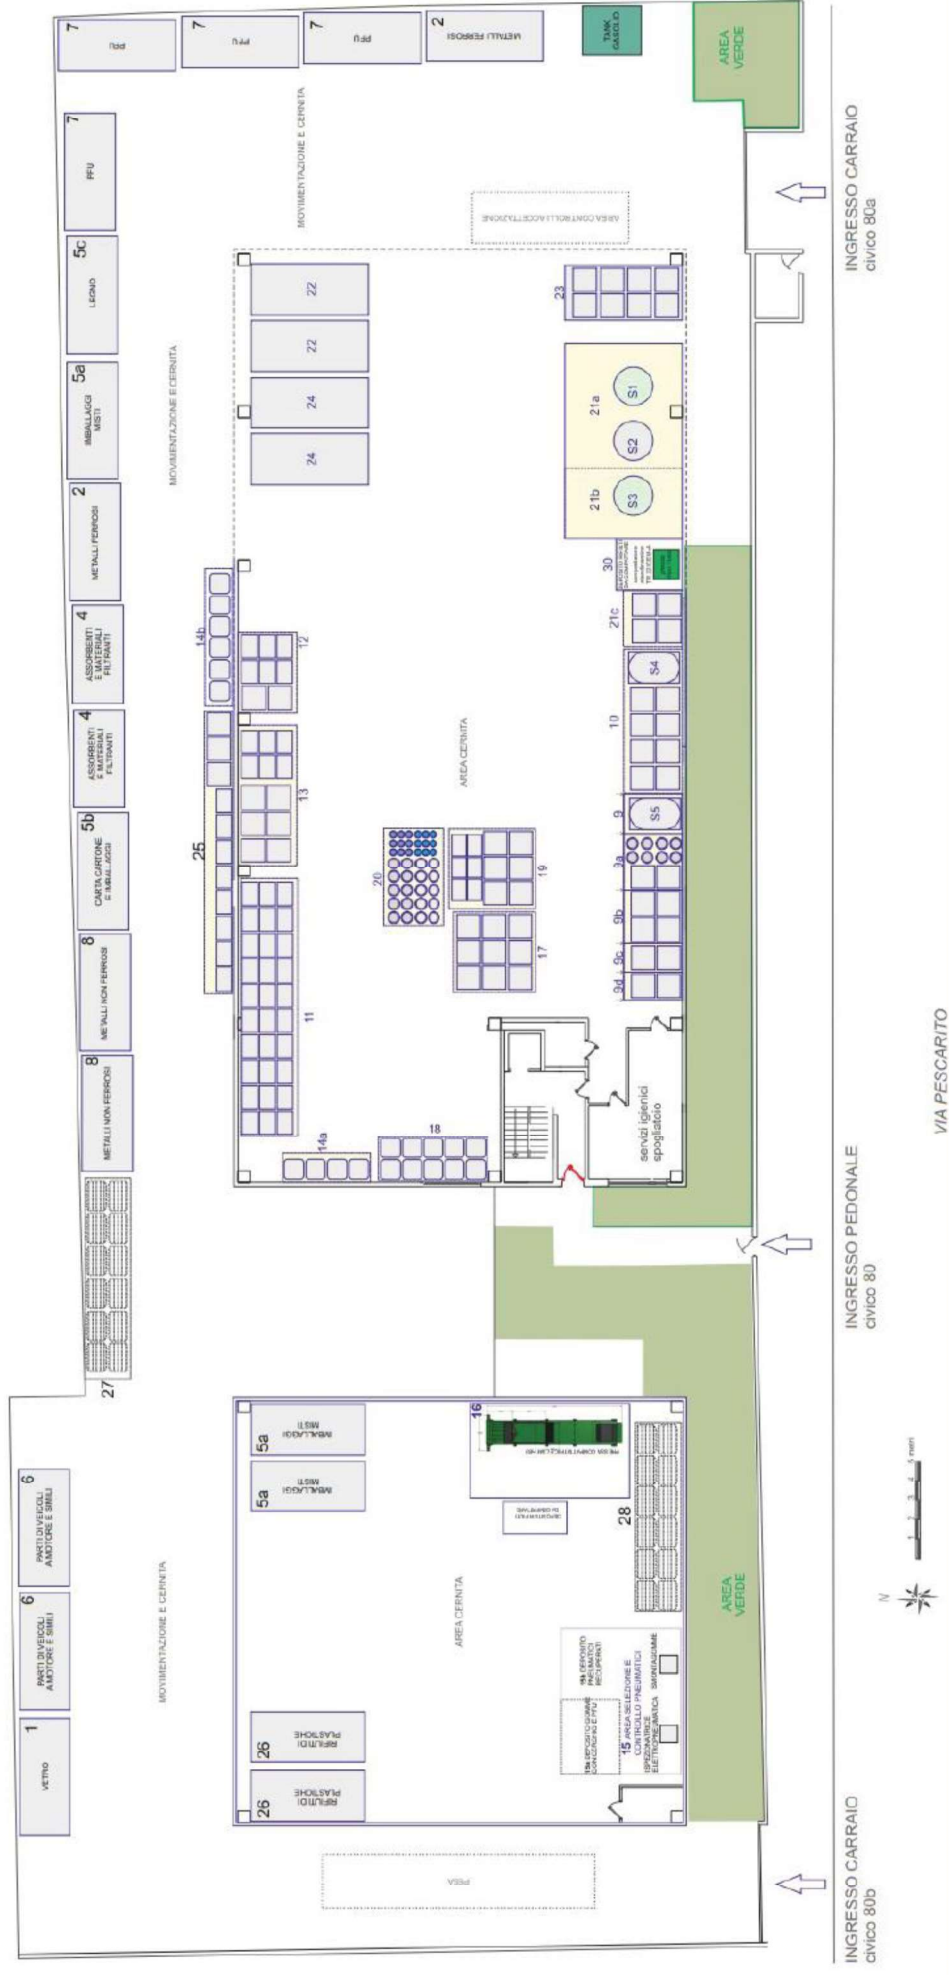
LAYOUT AUTORIZZATO CON AIA n. DD 5205 del 22/08/2023 e S.M.I
